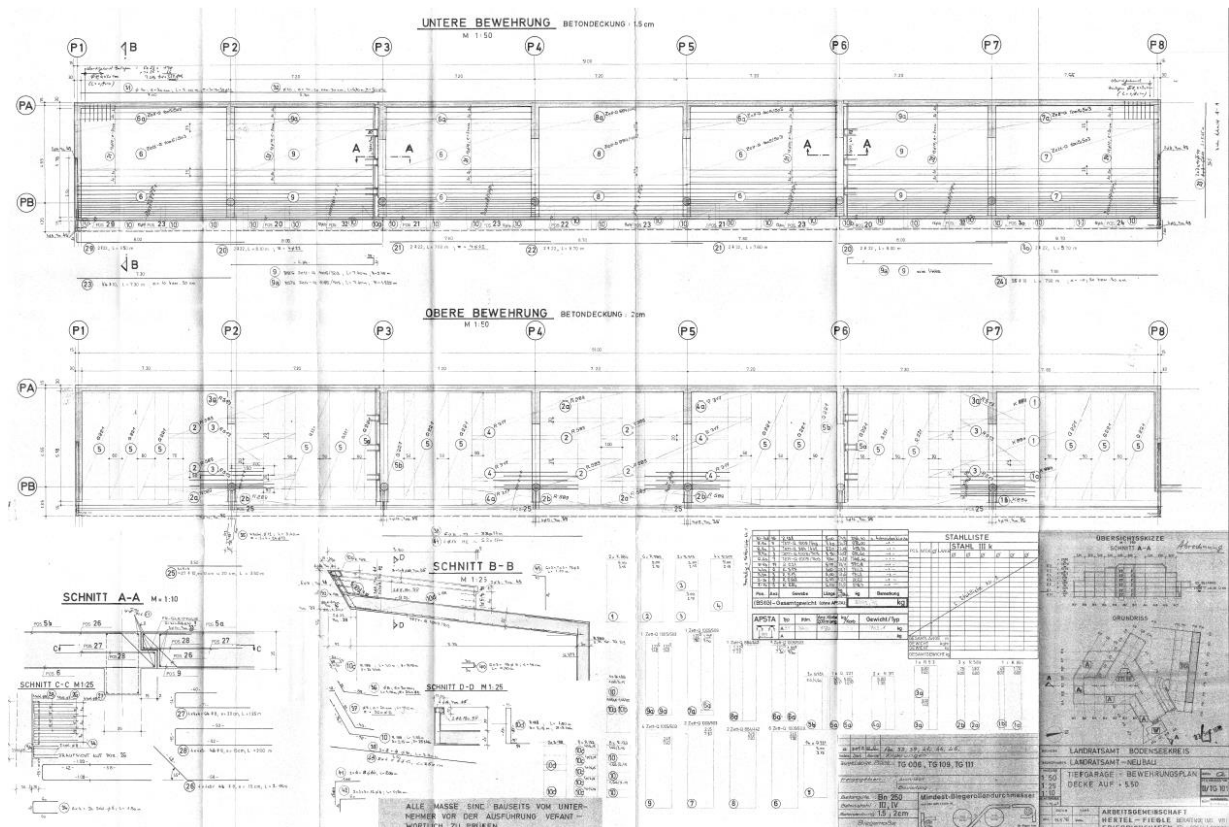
Bewehrungsplan Tiefgarage [B2]
